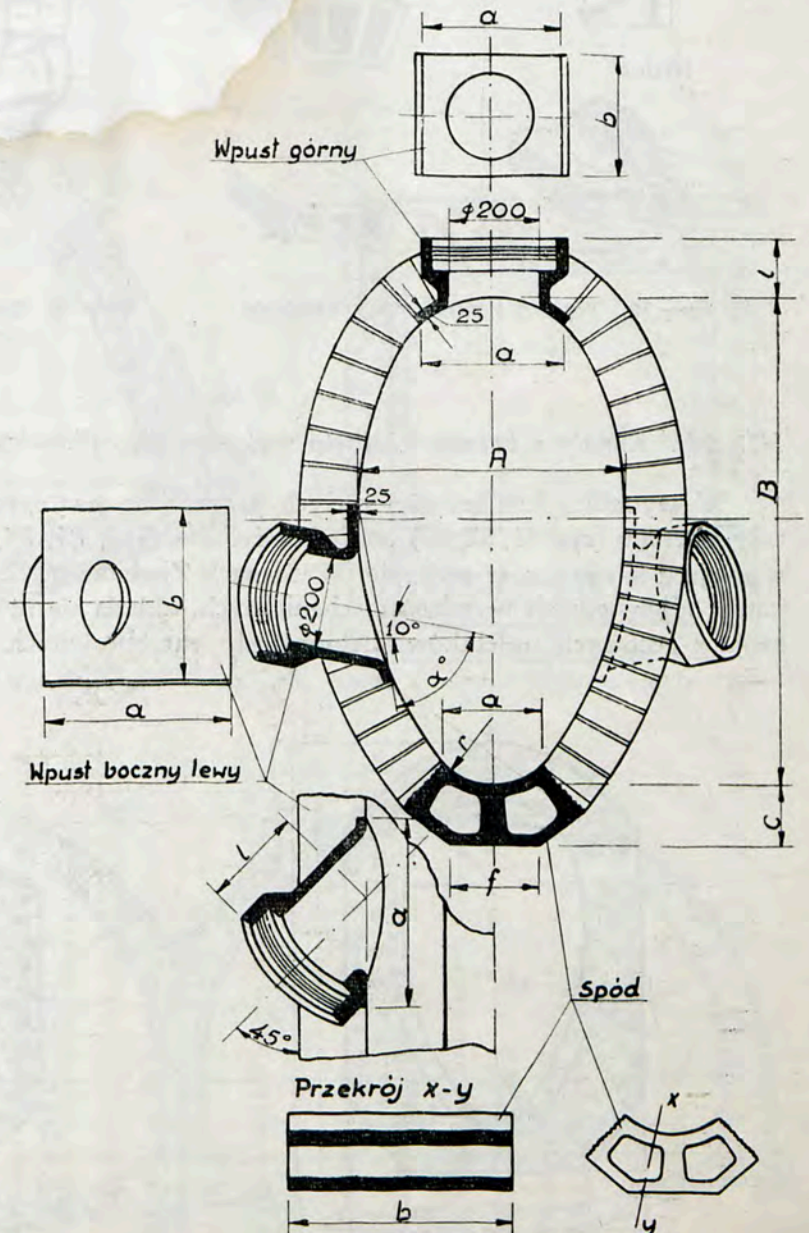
Kanał z cegły z obudową betonową w Berlinie.
